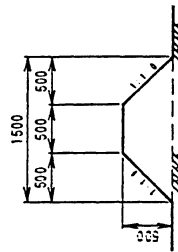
廃棄物等の掘削・移動工標準断面図
